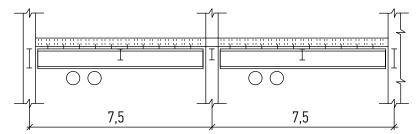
Схема типового перекрытия с короткопролетными стальными балками
